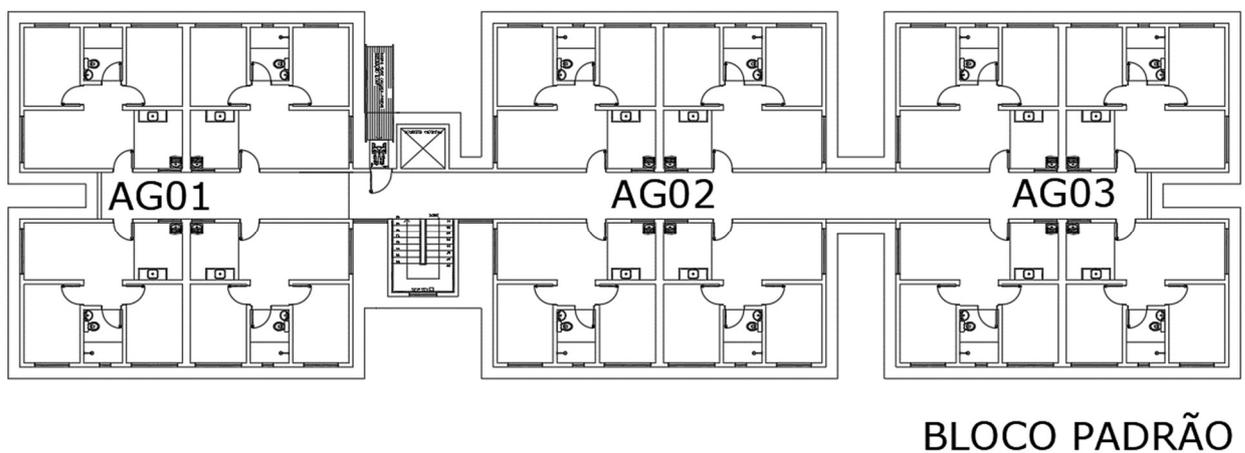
Contorno do pavimento tipo do empreendimento A1
